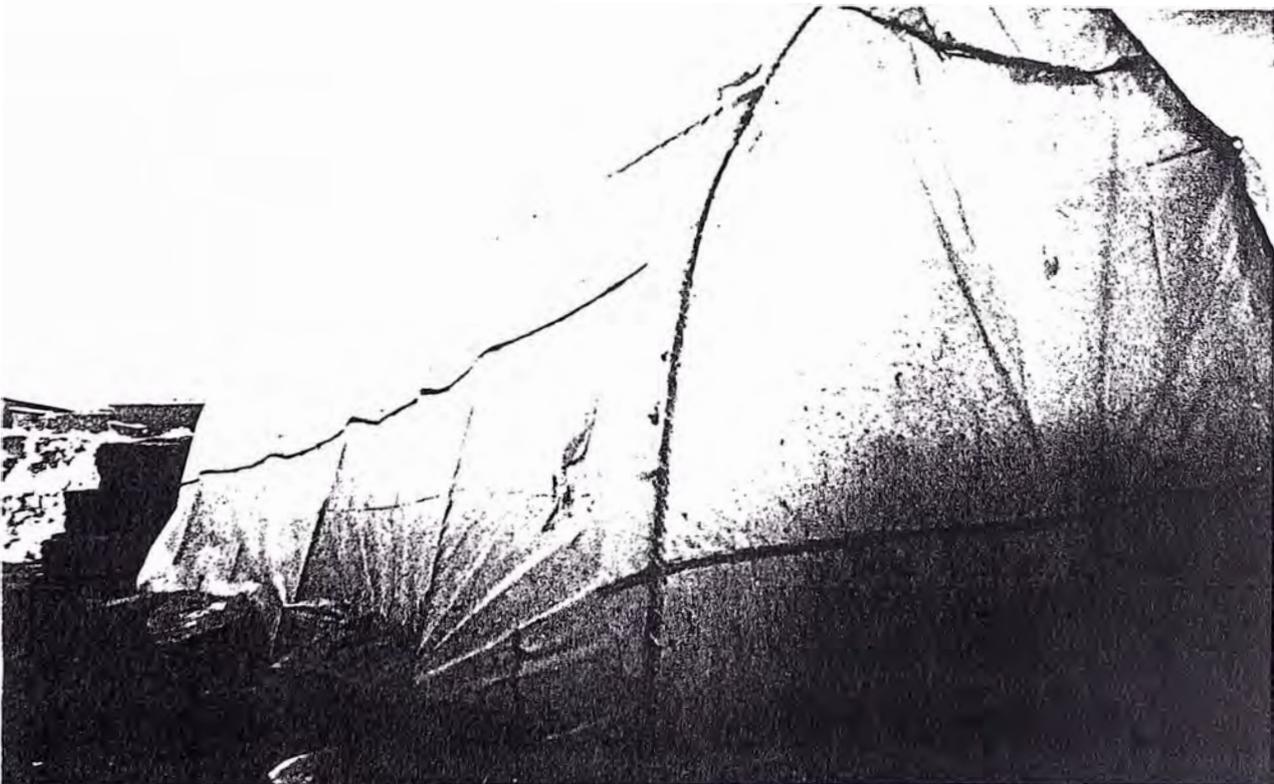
Invernadero construido sin enterrar(invernadero tipo "tunnel")
